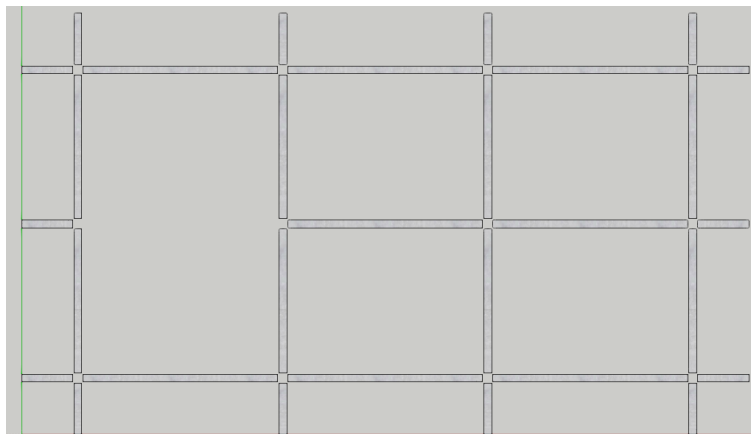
20 denah Lt 1 bangunan kantin stital.
